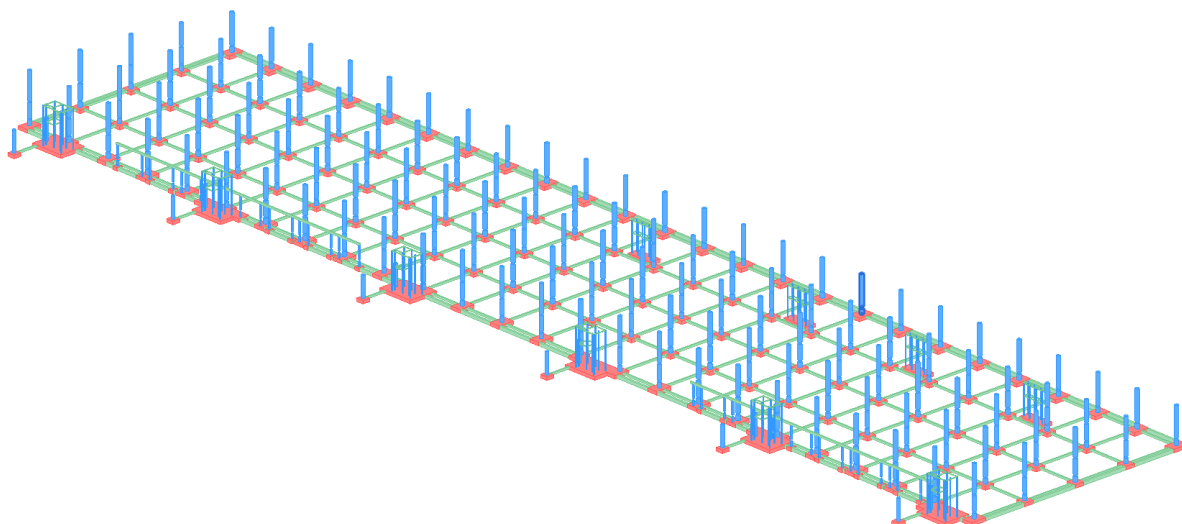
Vista 3D de la estructura. En rojo, losas y zapatas; en verde, vigas de atado; y en azul, pilares.
